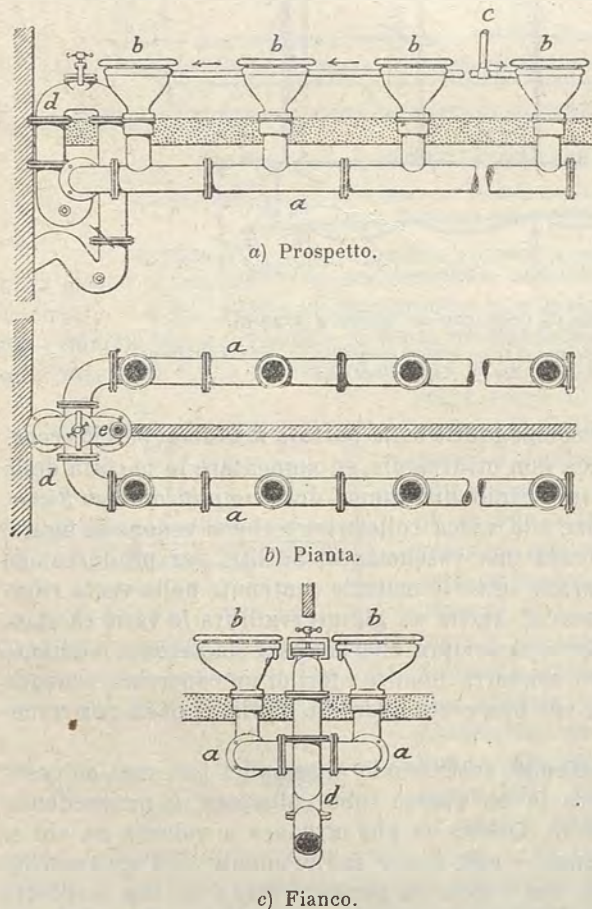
a, b, c. — Doppia batteria di cessi con collettori sotto il pavimento.
